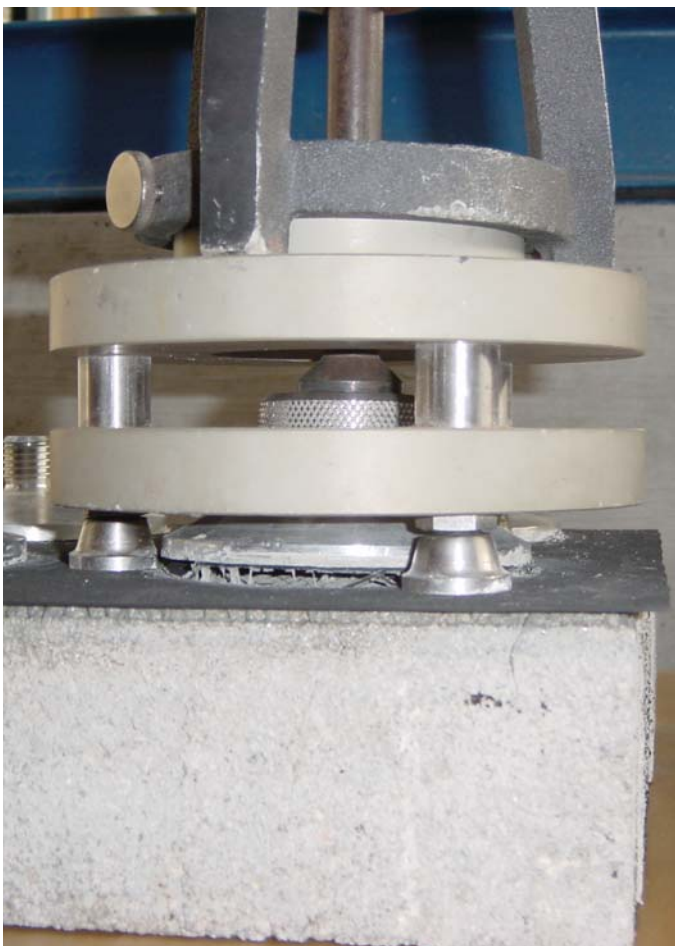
Haftverbund zwischen Klebschicht und Betonuntergrund, Detail
